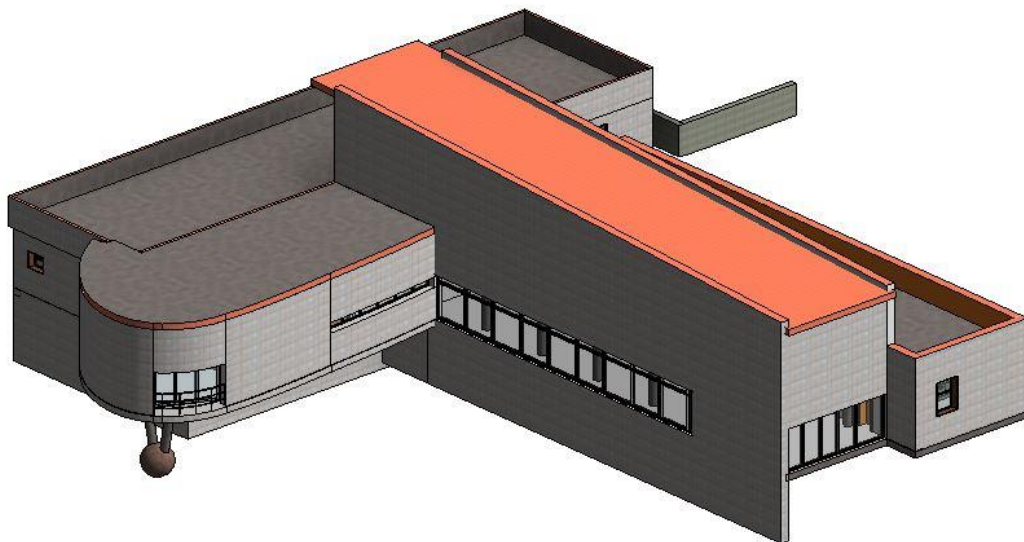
Vista 3D de las fachadas con acabado en bloque.
